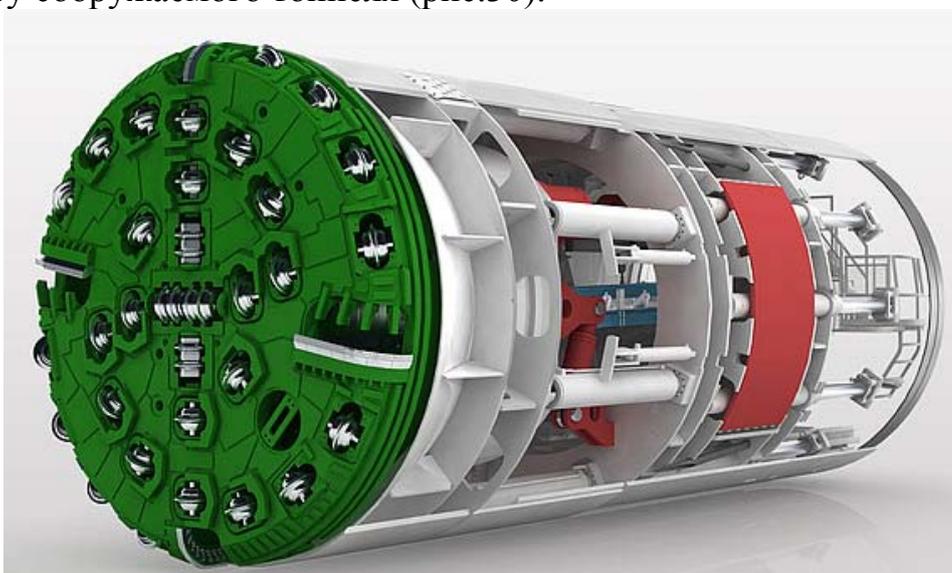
Установка для щитопроходческих работ Double Shield TBM фирмы Herrenknecht
